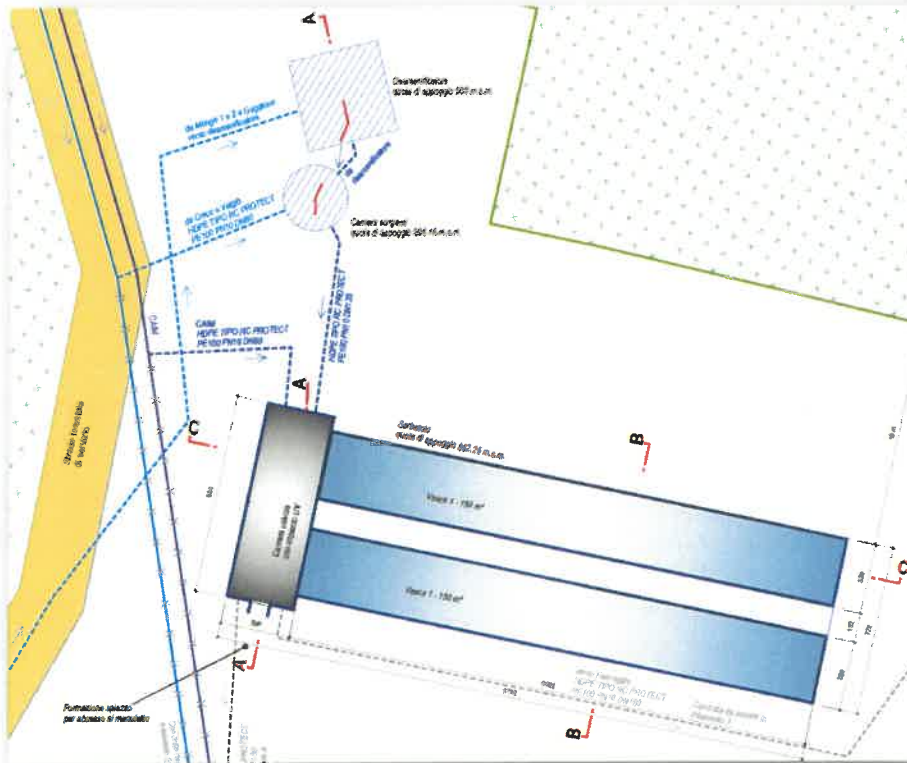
Stralcio planimetrico delle opere previste in progetto dall'intervento 1
